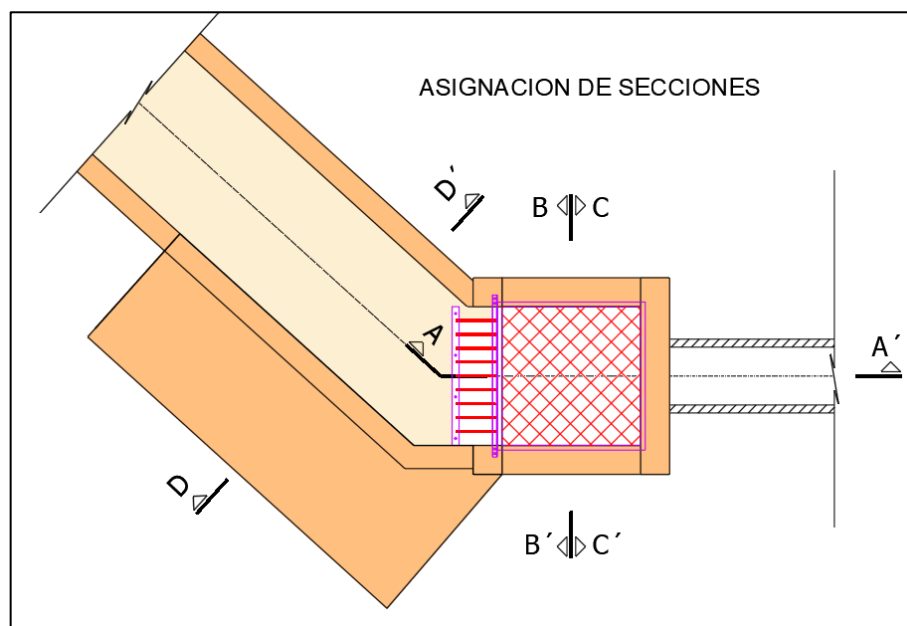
Vista en planta de la obra de fábrica del desagüe de fondo y asignación de secciones.
